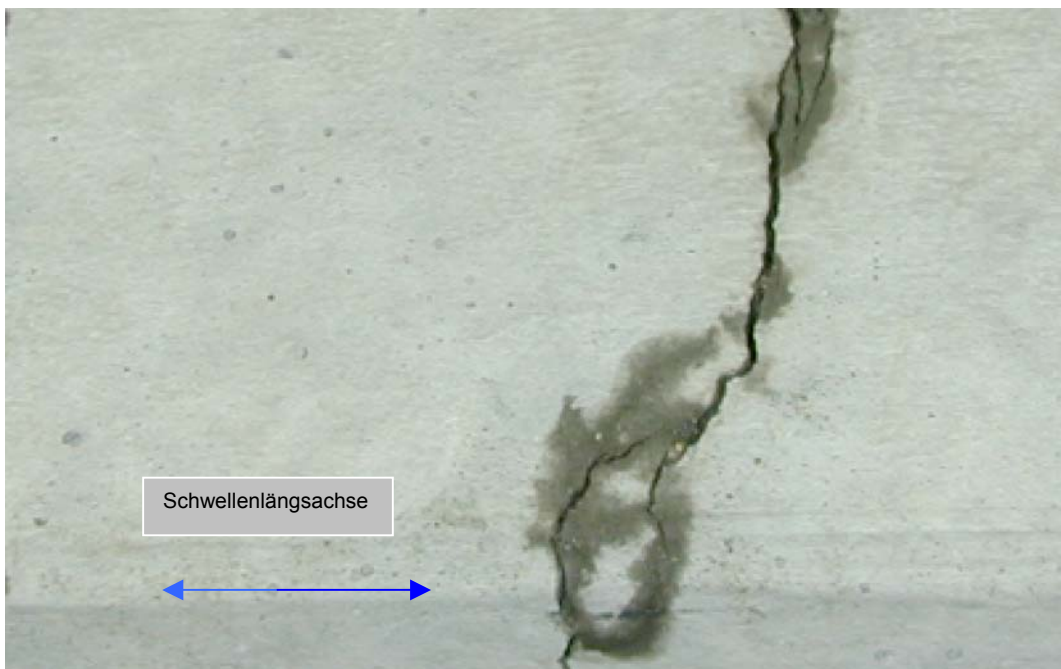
Schwellenmitte, Riss „klaffend“, Schadenklasse 1
